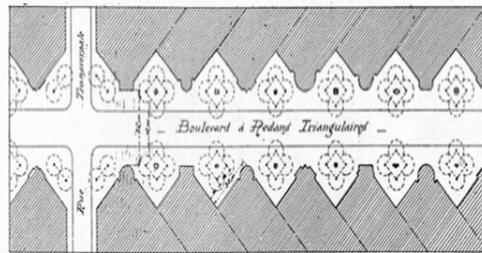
PLAN D'UN FRAGMENT DE BOULEVARD
